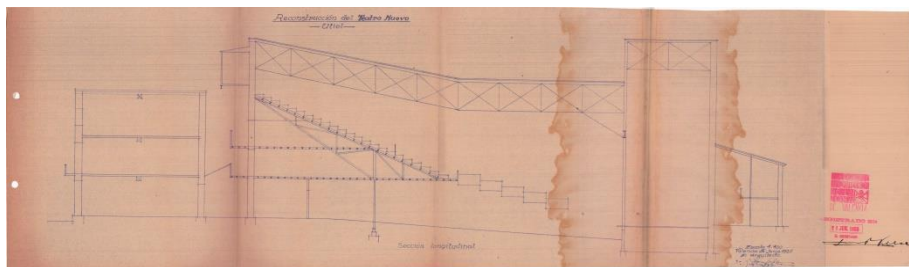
Sección longitudinal de la reconstrucción del Teatro Rambal
